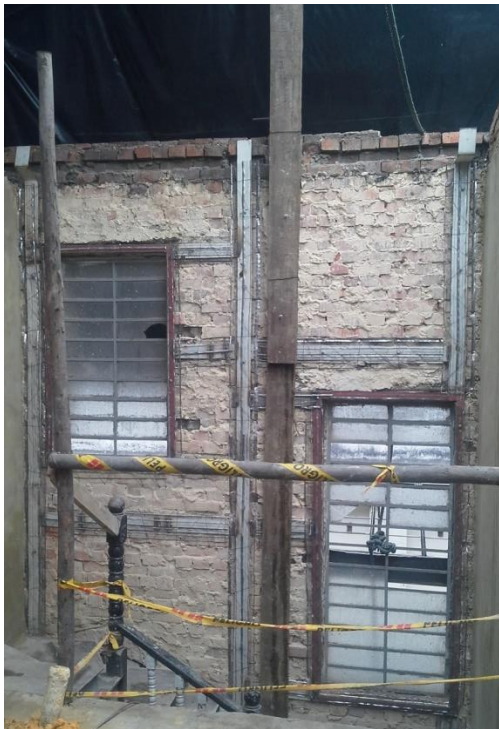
, Fundida de la viga de coronamiento del muro. Fuente Imagen propia
